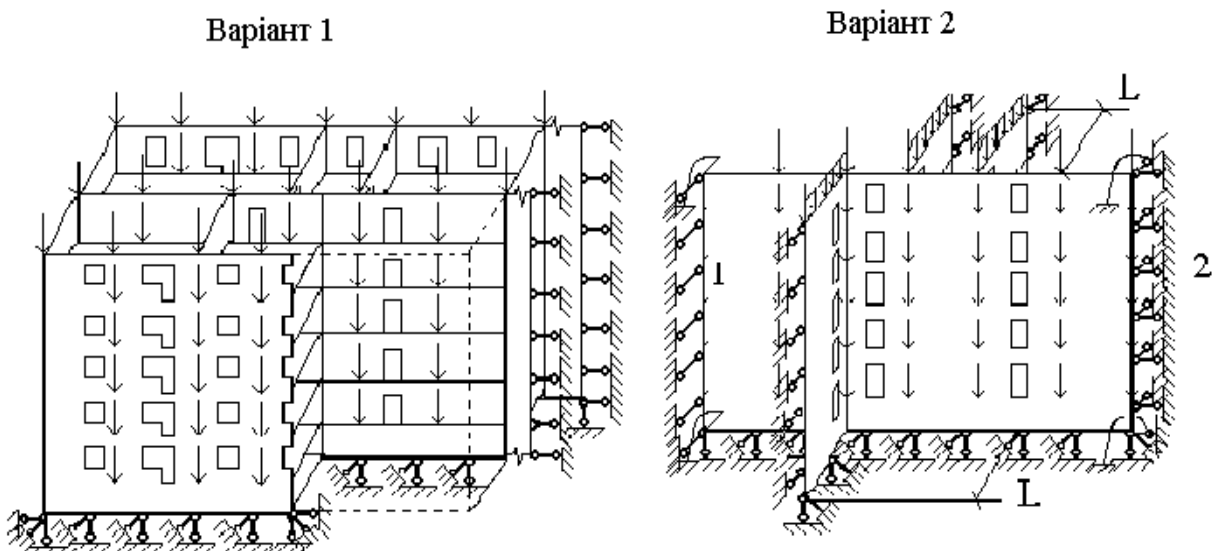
Схематичне зображення розрахункових схем першого та другого варіантів розрахунку: 1, 2 - стрижневі КЕ, що моделюють поперечні стіни будівлі.
